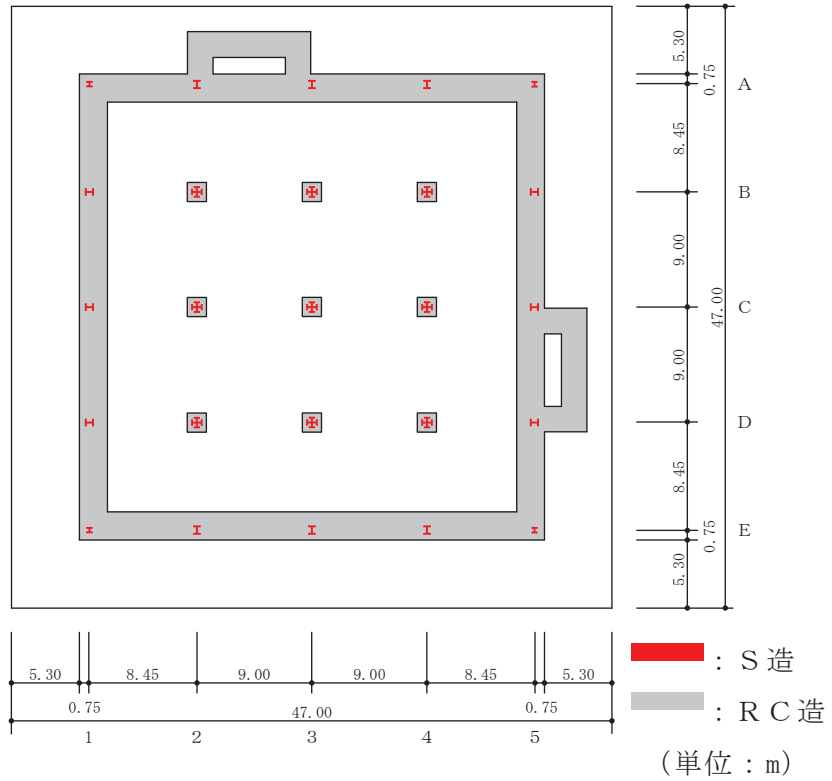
(1) 緊急時対策建屋の概略平面図 (O.P. 51.5m)
